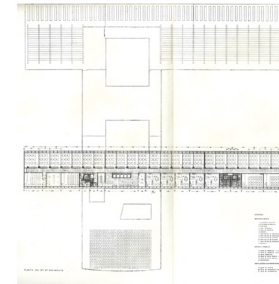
Planta baixa do pavimento-tipo do projeto para o edifício da FNA na Cidade Universitária, Rio de Janeiro.
